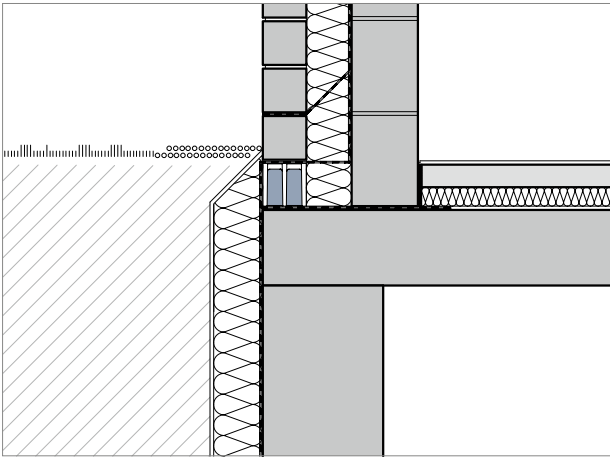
Schöck Sconnex® Typ M bei zweischaligem Mauerwerk
